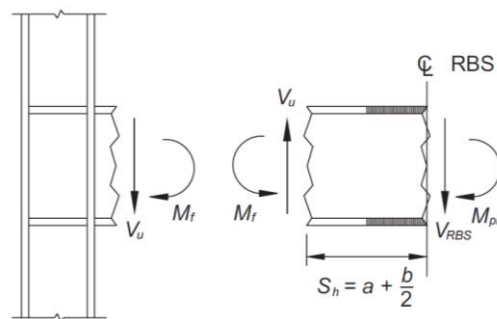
Diagrama de cuerpo libre de segmento entre cara de columna y centro de sección reducida (*American Institute of Steel Construction, 2016*).
